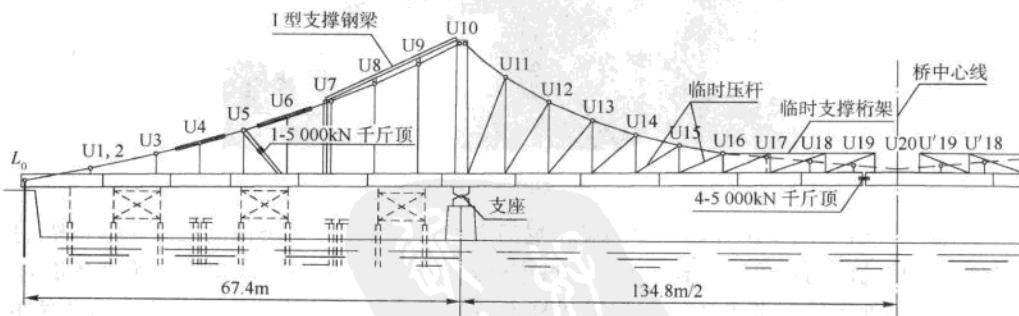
美国匹兹堡市阿勒格尼河第七街桥施工示意图(尺寸单位:m)
